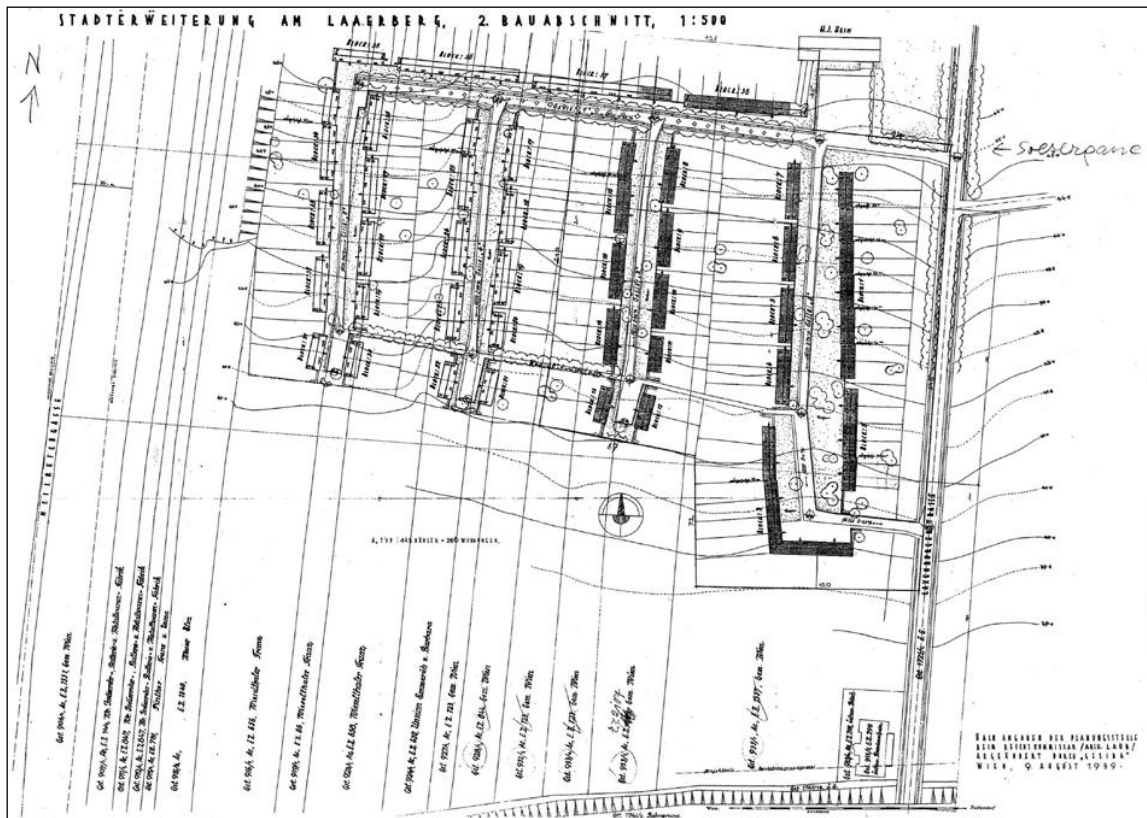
Lageplan Wienerfeld West, Planung von 1939
